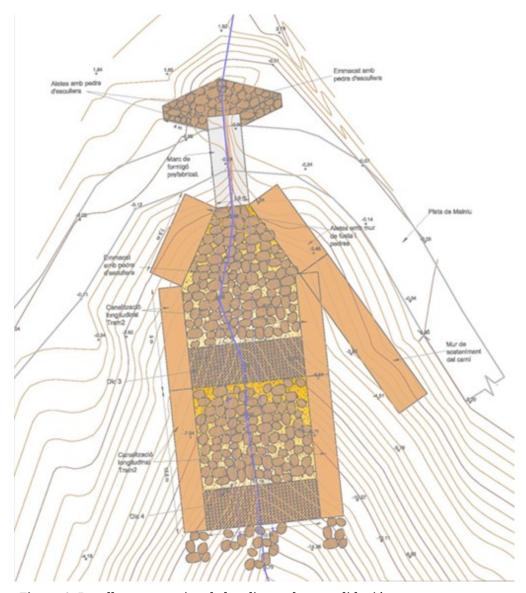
Detalle constructivo de los diques de consolidación y muros con estructura Krainer.
